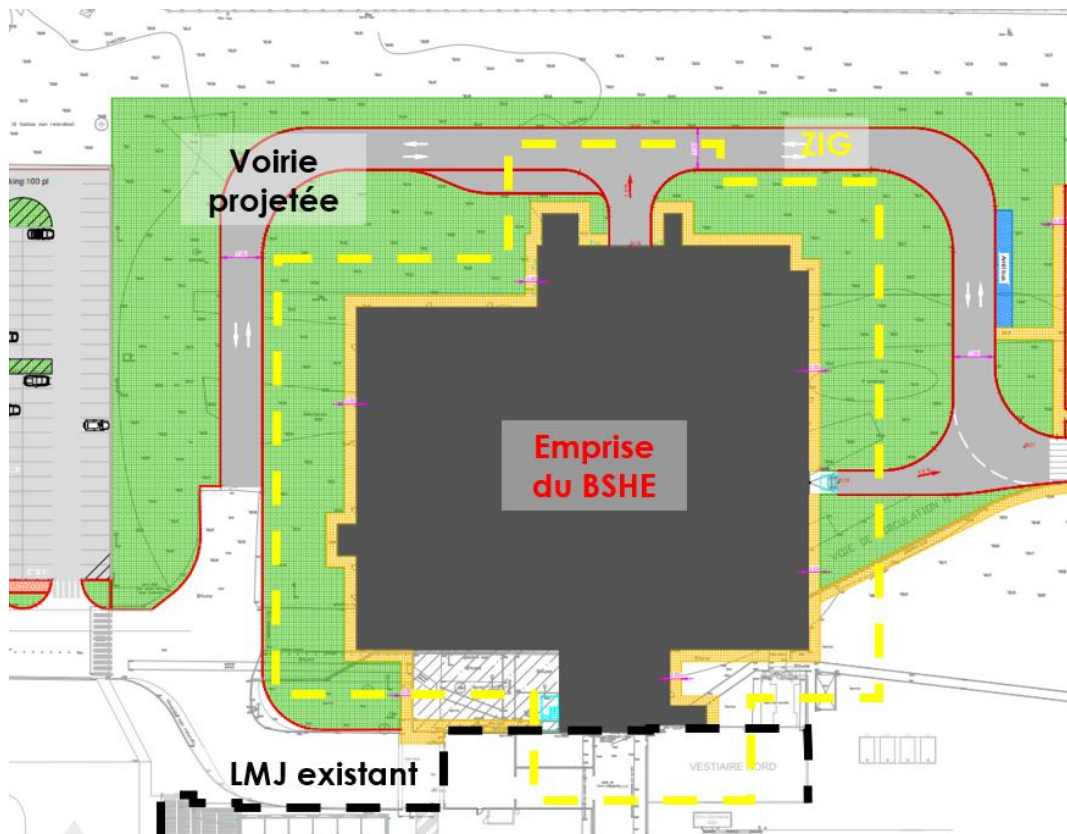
Plan de masse du projet et implantation de la ZIG – Sans échelle
